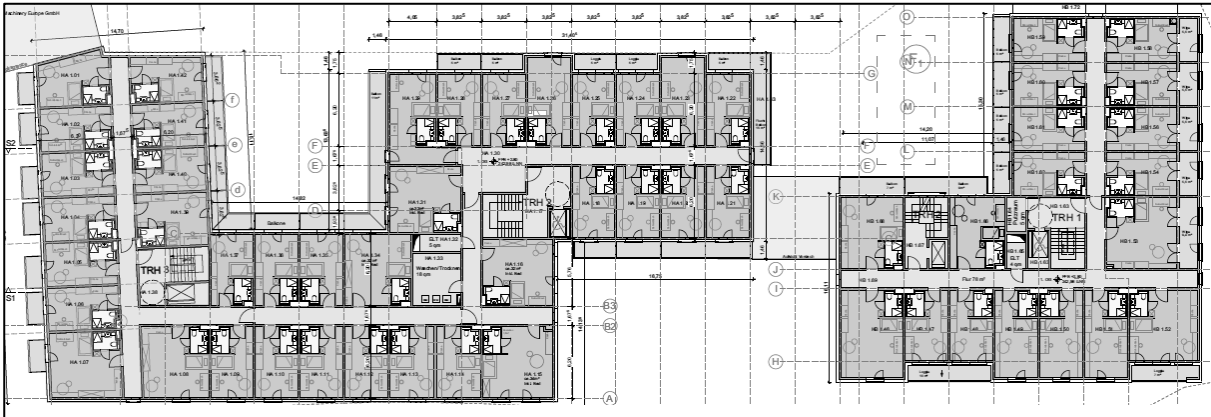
Ausschnitt Grundriss 2. OG
